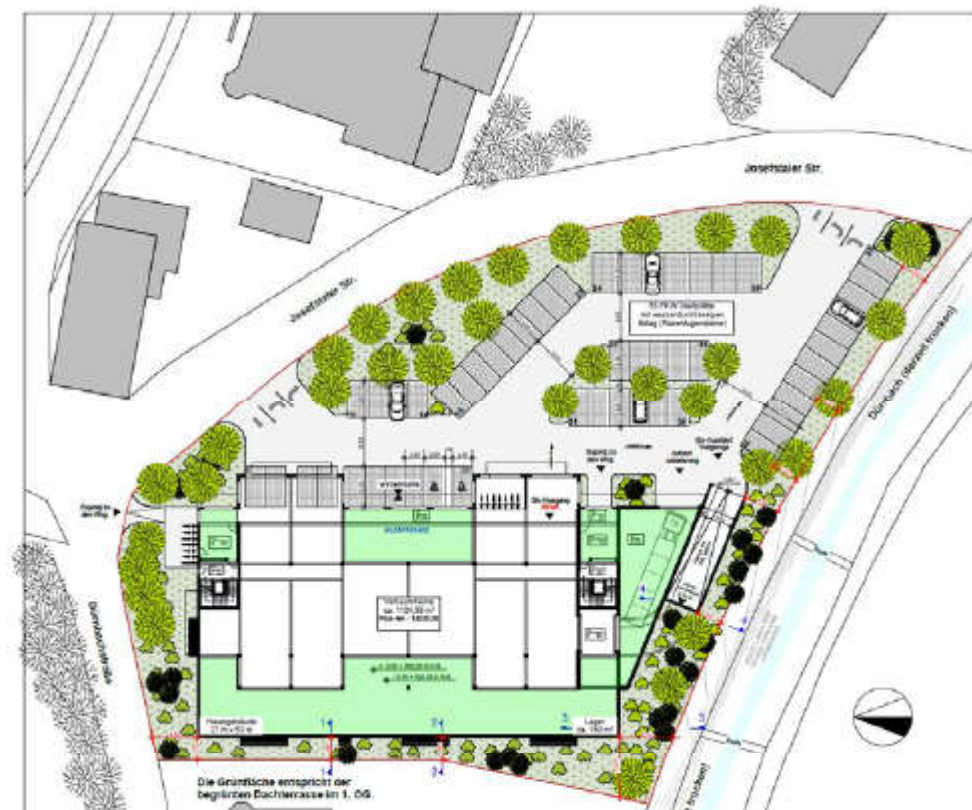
Präsentation „Neubau eines Geschäftshauses mit Wohneinheiten und einer Tiefgarage“, Lageplan, Planverfasser: ada PLANUNGS- UND BAUCONSULTING GMBH & CO. KG, Geretsried, Stand 19.06.2020,
